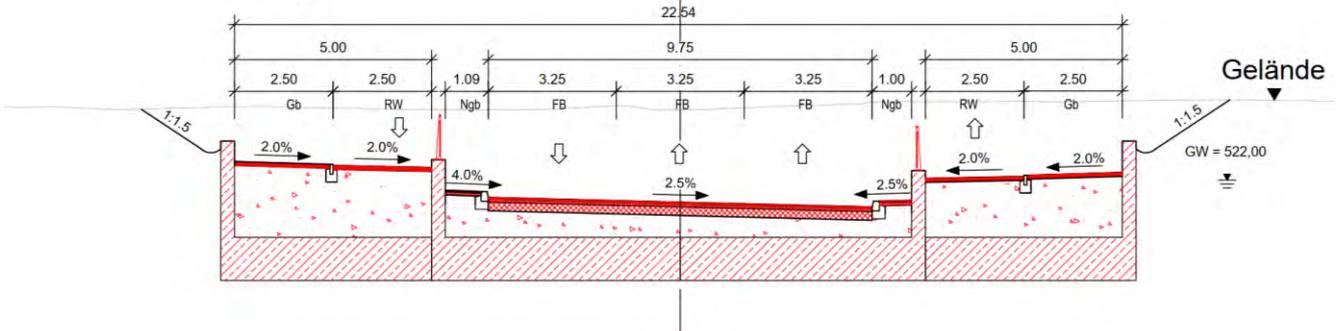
Straßenquerschnitte Eisenbahnüberführungsbauwerk Aubinger Allee, Trogbauwerk
